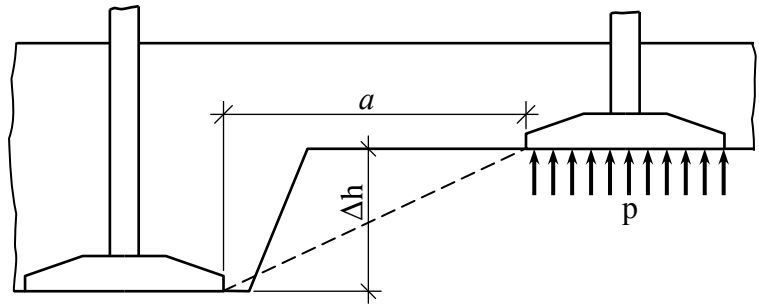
Схема примикання фундаментів, які проектують, до існуючих
